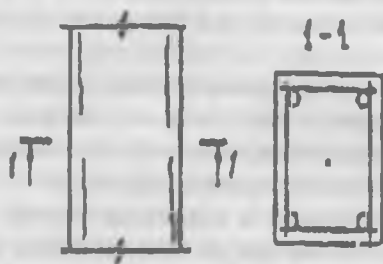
Трещины вдоль продольной арматуры в сжатых элементах.
